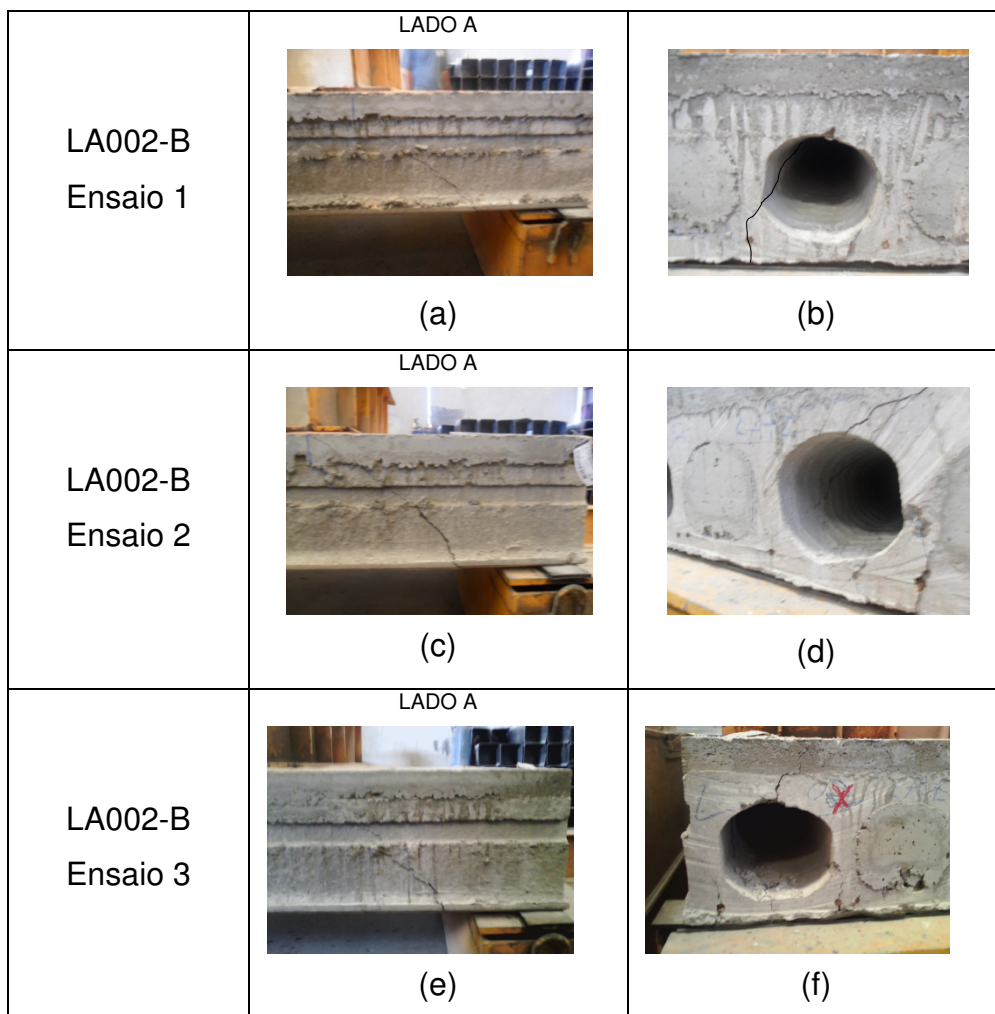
FISSURAS DAS LAJES LA002-B APÓS OS ENSAIOS.
